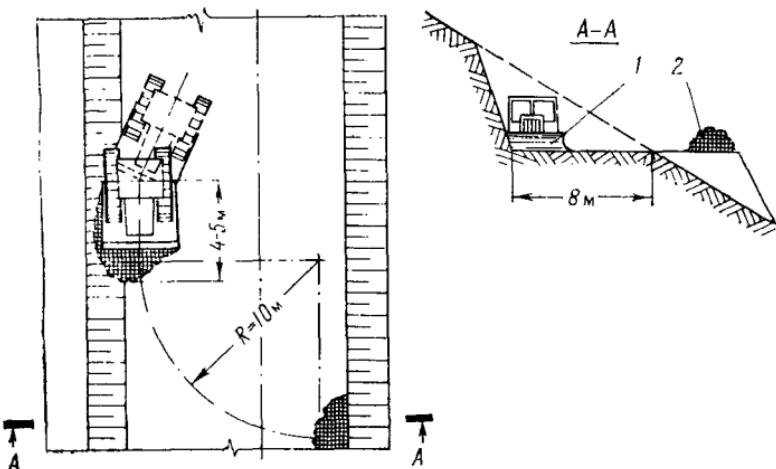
Схема разработки полувыемок-полунасыпей на крутых склонах продольными проходами бульдозерами:
